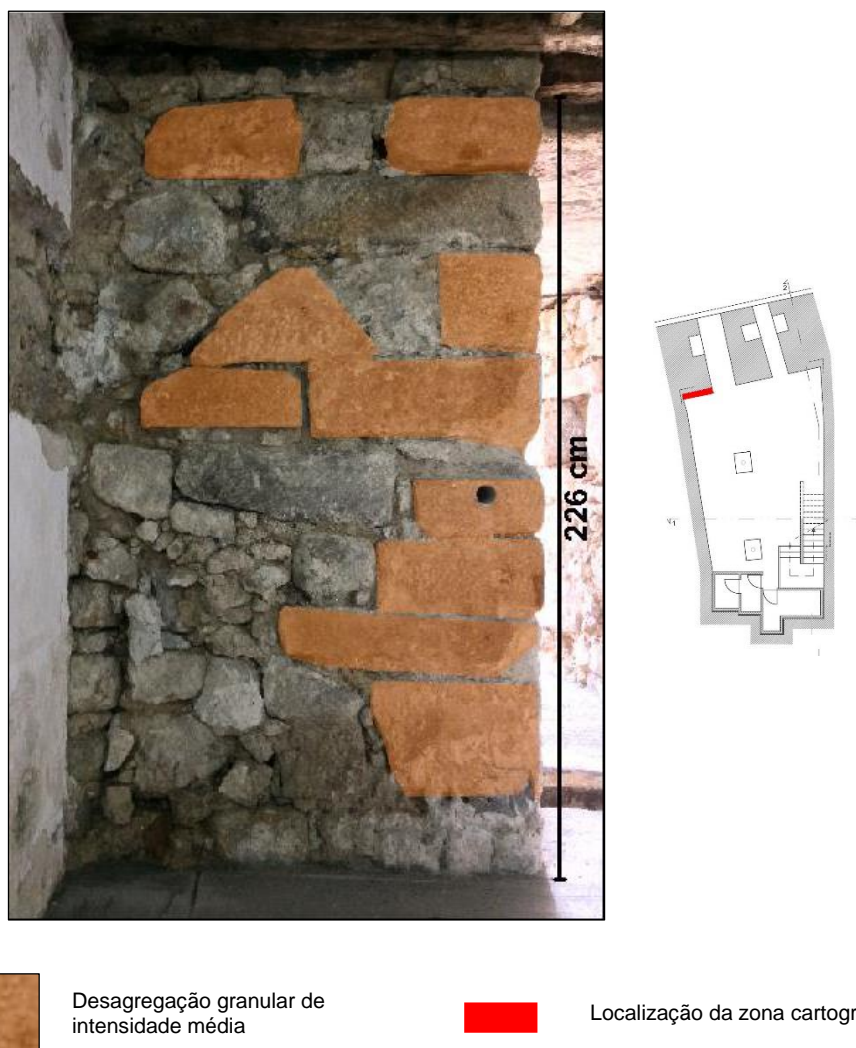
7: Cartografia das deteriorações – Interior – Fachada Sul – Piso -2 – Muro de suporte – Lado esquerdo
